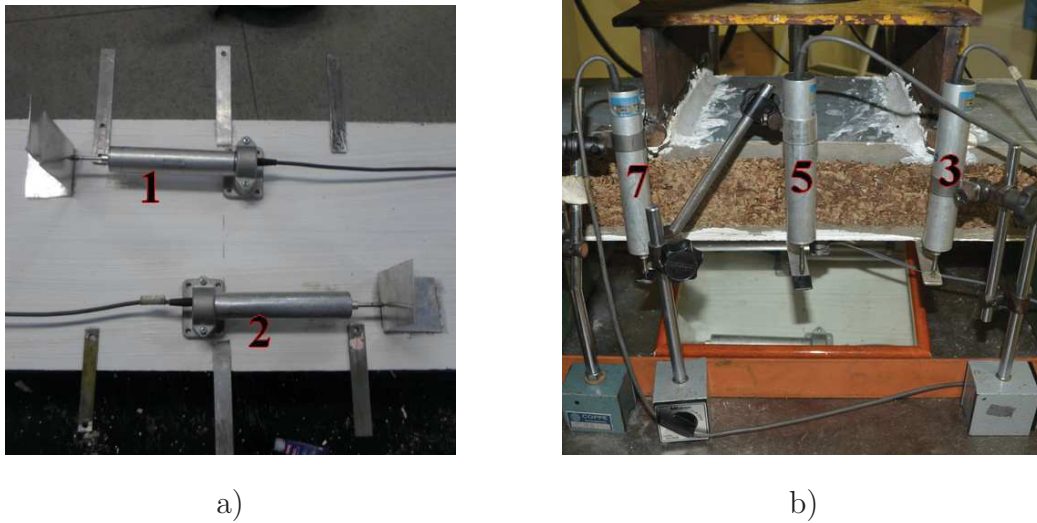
Montagem dos LVDTs 1 e 2 a) b) Disposição dos LVDTs 3,5 e 7
